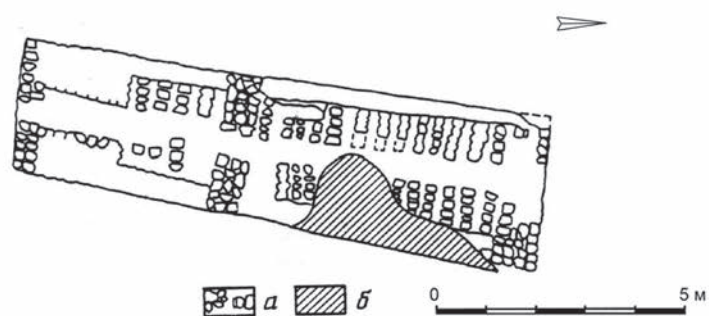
Баня на городище Большая Тояба: а – кирпич; б – нарушенная часть здания
